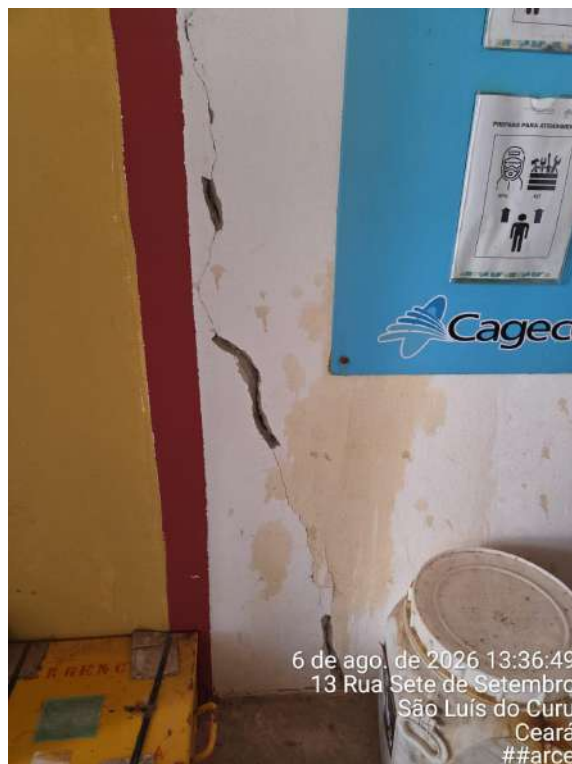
Casa de química da ETA: rachaduras, fissuras e desprendimento do revestimento da parede, com sinais de umidade.
